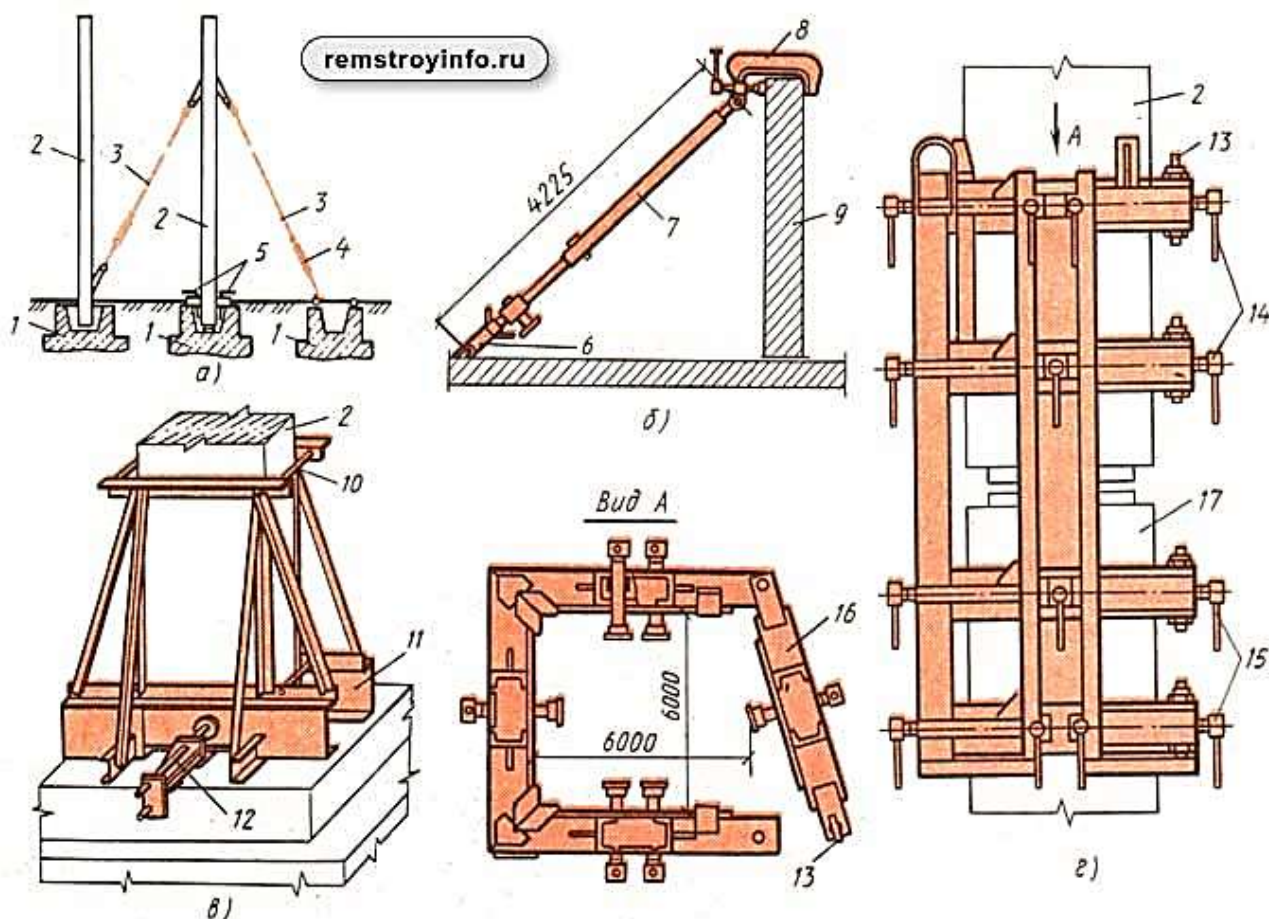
Приспособления для временного закрепления и выверки строительных конструкций
